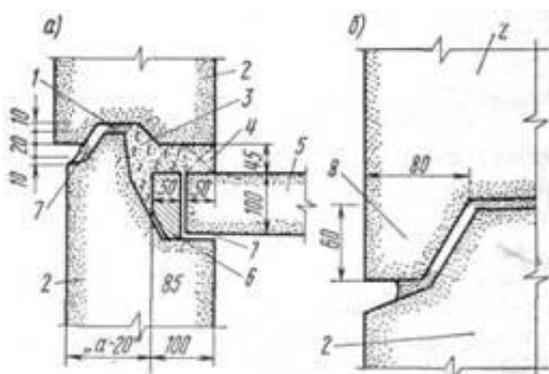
Конструкции горизонтальных стыков наружных стеновых панелей: а — с противодождевым барьером; б — то же, с зубом; 1 — прокладка из пористой резины; 2 — наружная стеновая панель; 3—цементный раствор состава 1 : 3; 4 — монтажная прокладка (2 шт. на панель); 5—панель перекрытия; 6 — вкладыш из минераловатных плит толщиной 50 мм, обернутый в пергамин, или из пенопласта; 7 — зачеканка раствором; 8 — зуб
